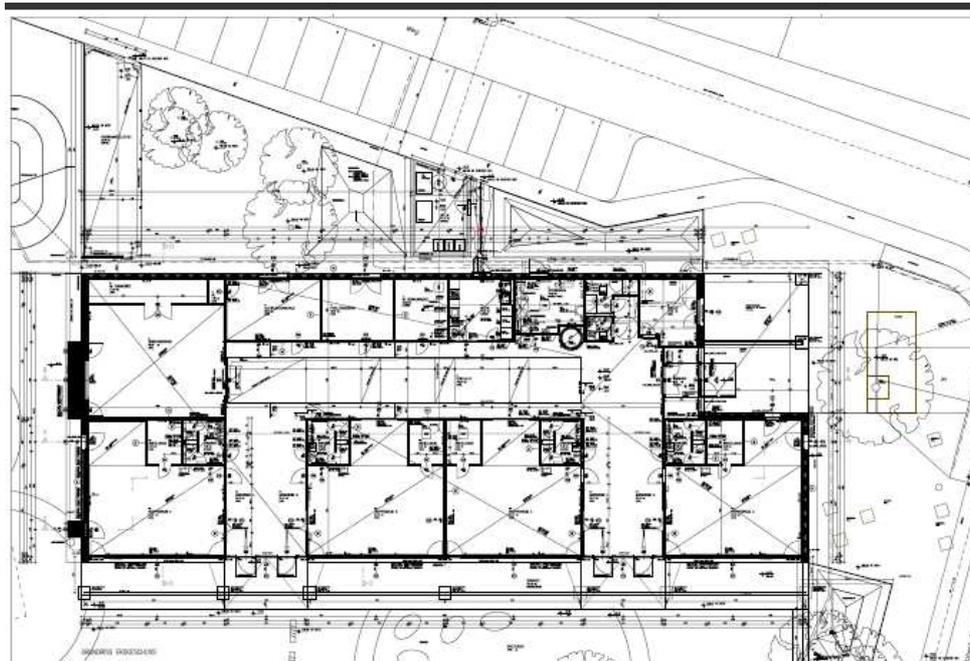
Grundriss des Kindergartengebäudes [Architekturbüro Reinberg ZT GmbH]
